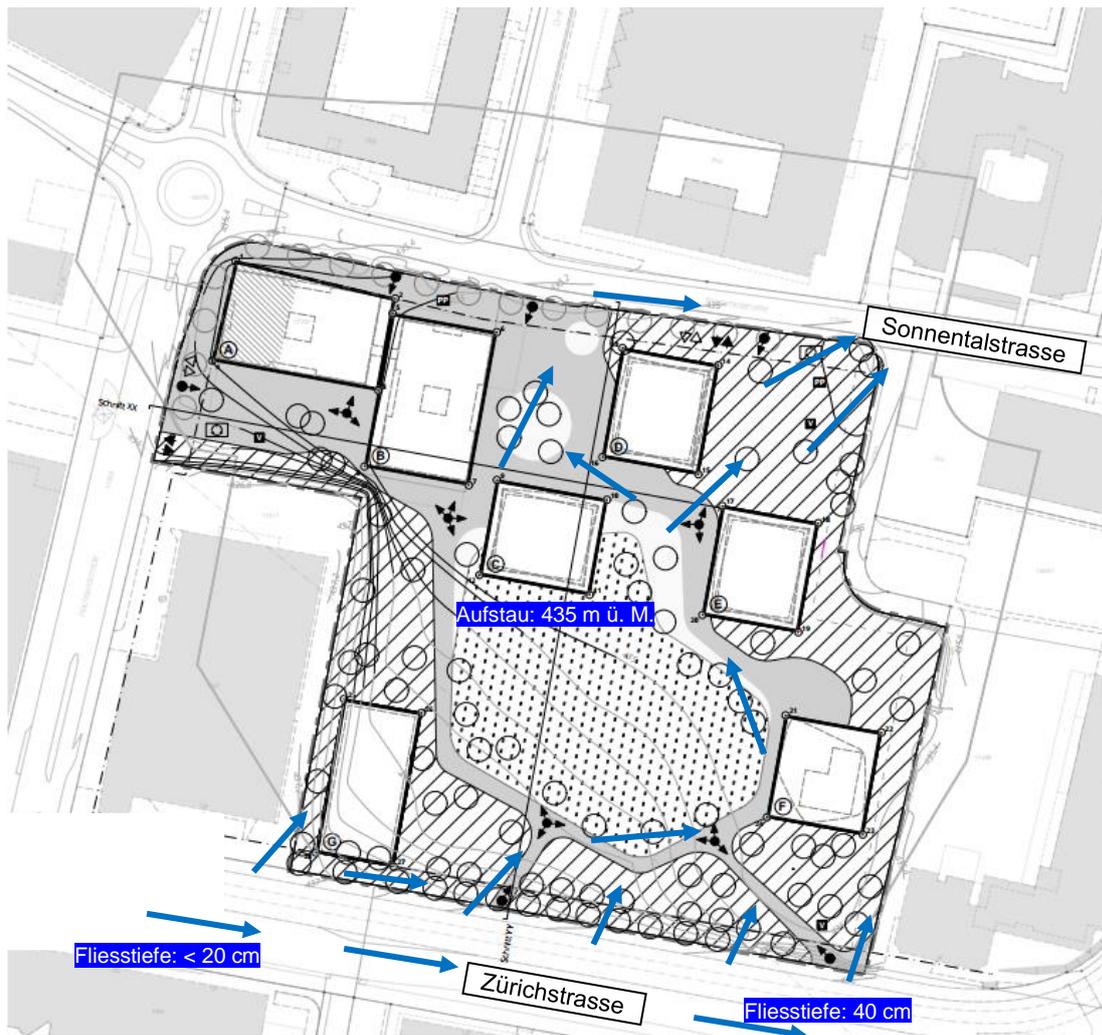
Planausschnitt Gestaltungsplan (Situationsplan vom 28.09.2020) mit Hochwassereinwirkungen, Flieswegen und Aufstaukoten
